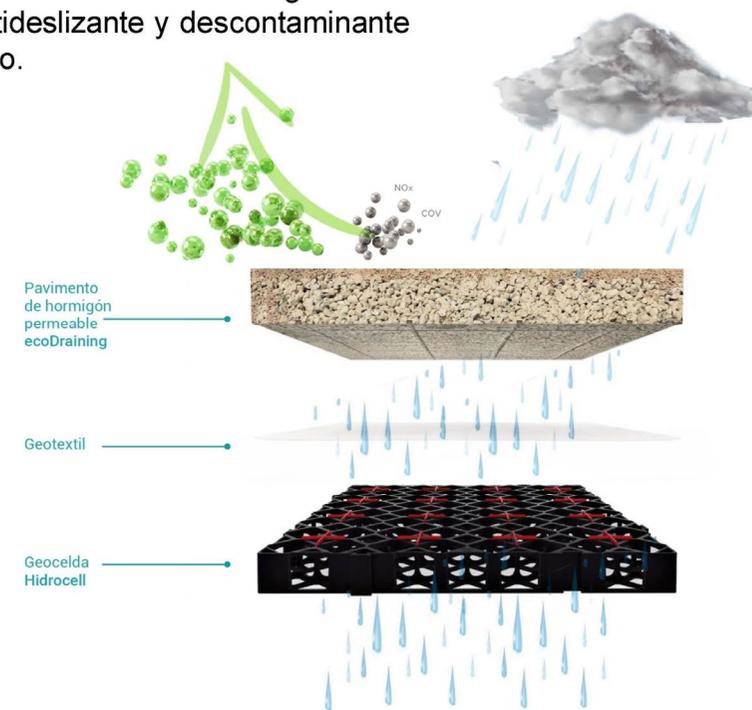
Esquema del sistema DPS con pavimento ecoDraining
